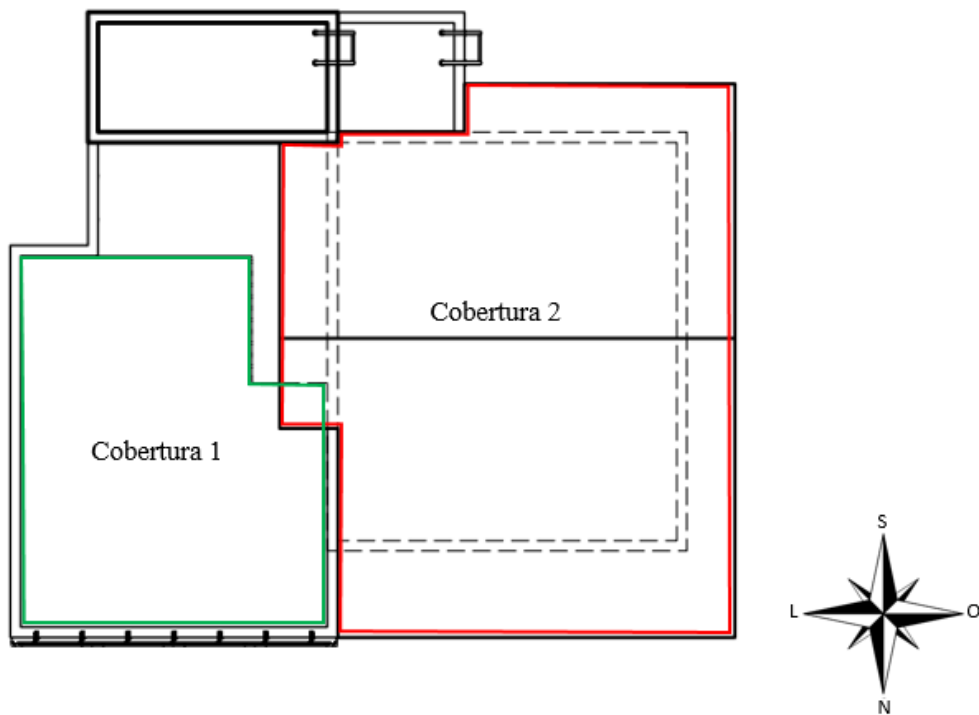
Posicionamento dos dois tipos de cobertura na Planta Piloto Bioclimática. Fonte: do autor.
